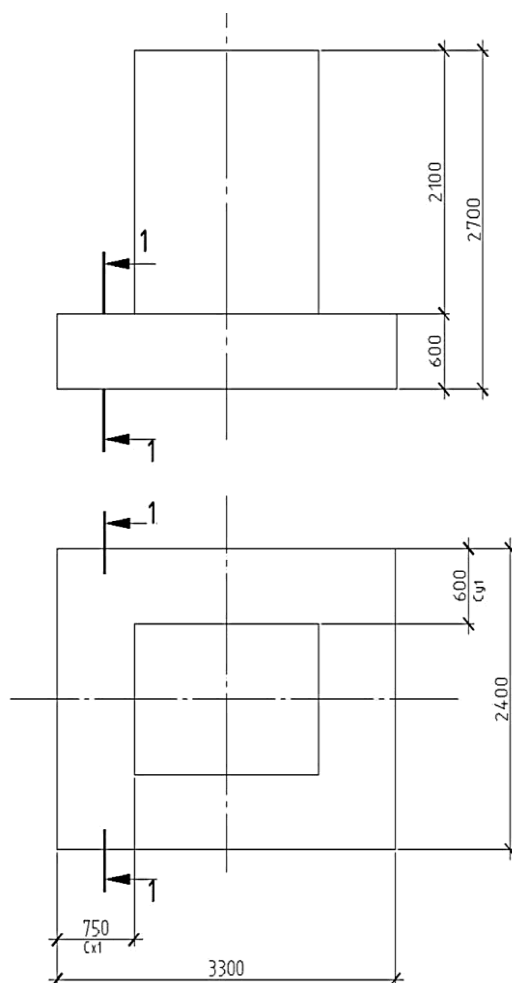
Перерізи для розрахунку плити фундаменту на вигин
